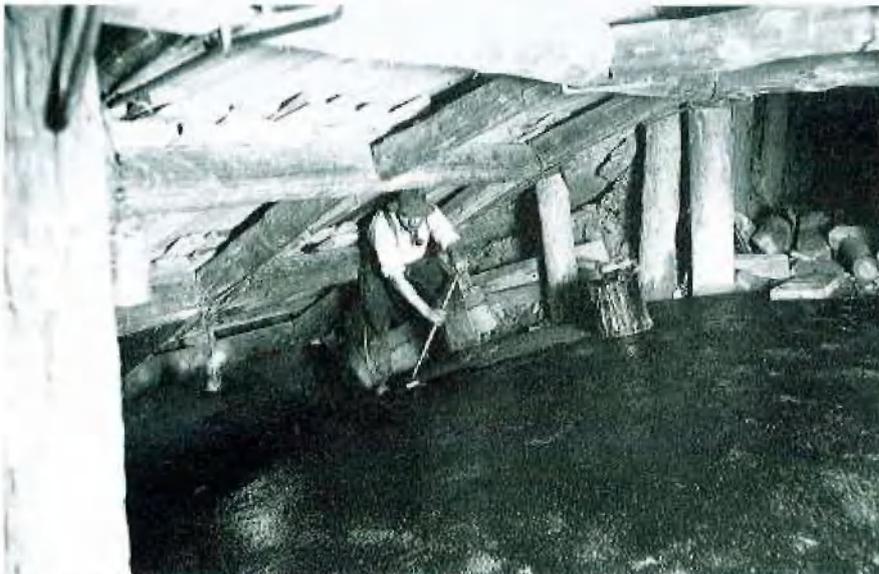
Abdichtung mit bituminösen Anstrich-Kurzenbergtunnel 1934
